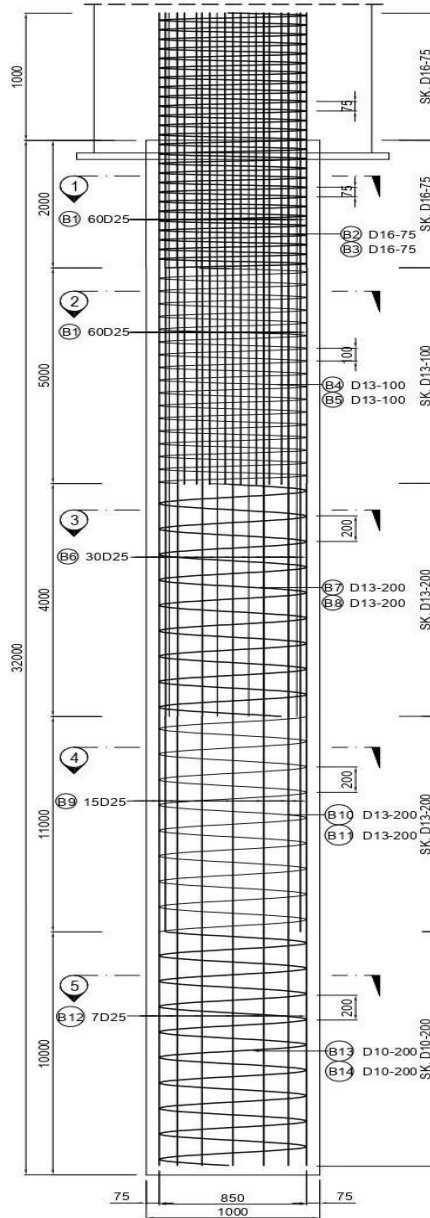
34 Tampak Atas Bored Pile Abutment 1
